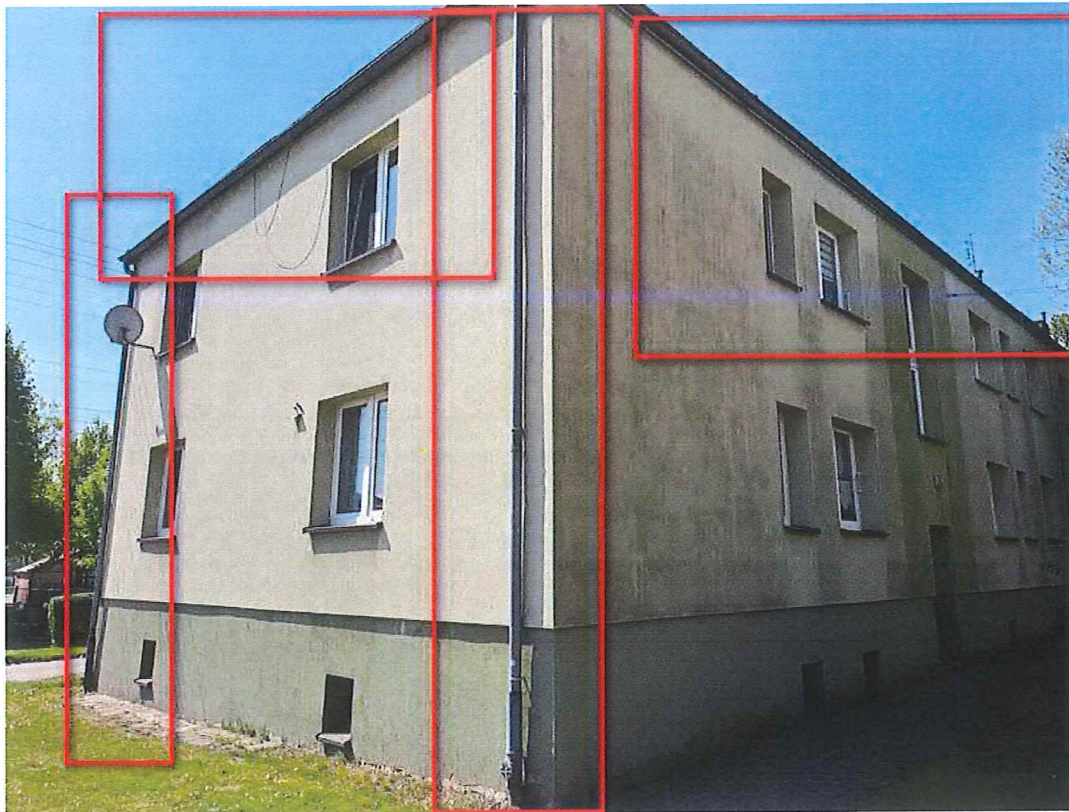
Widok elewacji bocznej (klatka schodowa nr A).
